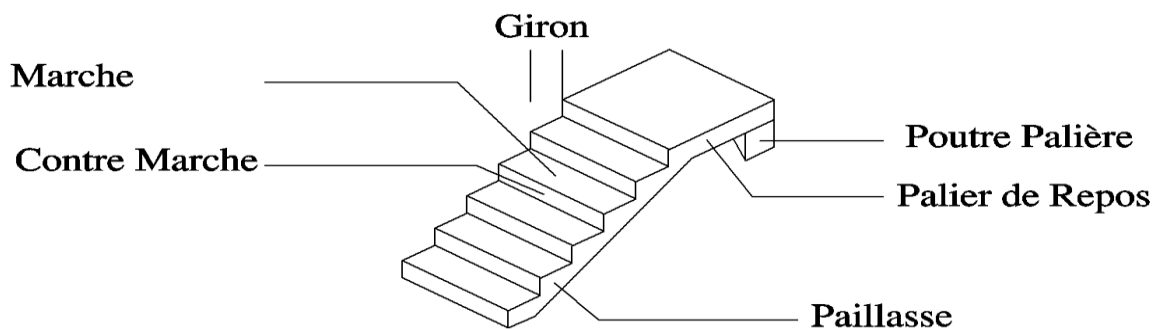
Schéma général d'une volée d'un escalier droit.
